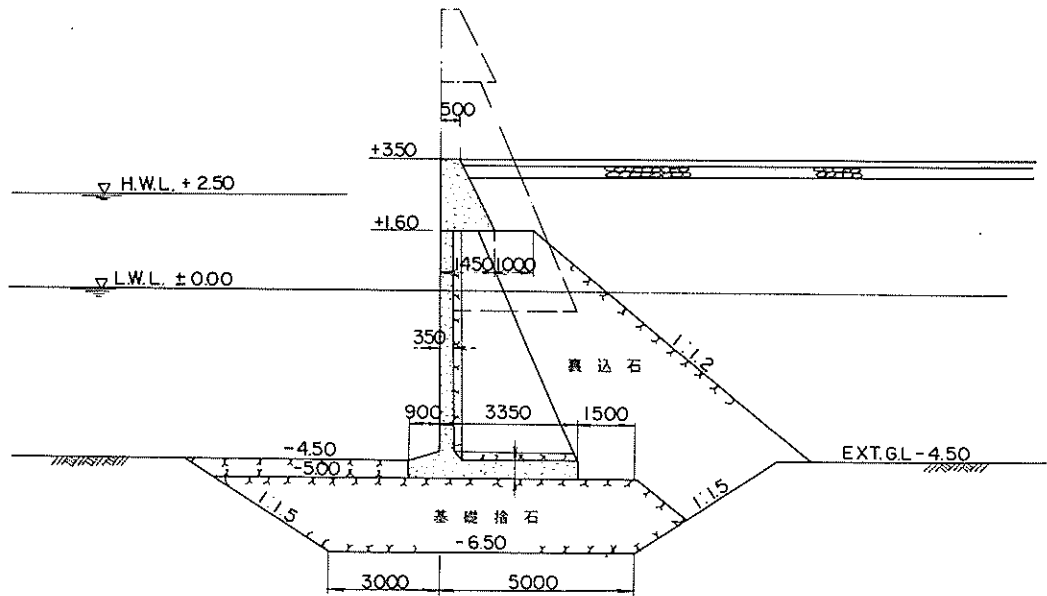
L型ブロック式-4.5m岸壁標準断面図(タイプA-6)
